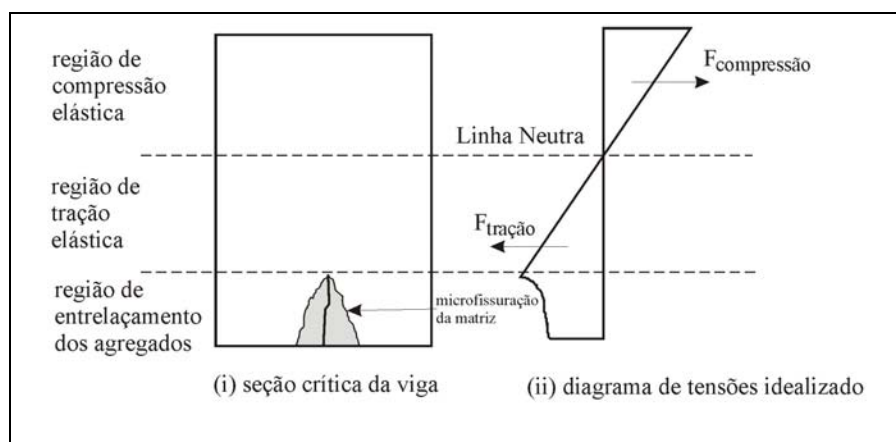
Representação esquemática da viga de concreto reforçado com fibras de aço sob o carregamento de flexão – Estágio 2: microfissuração (JONES, 1998).
